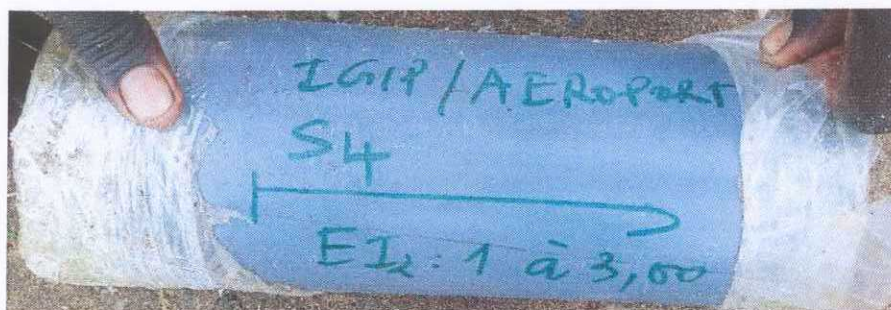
Photo des couches géologiques de SC4 entre 0,00 m et 3,00 m
